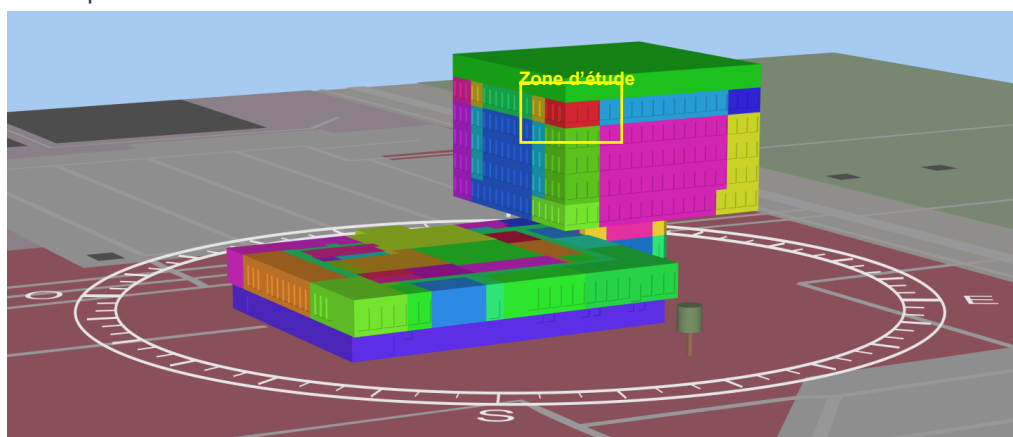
Plan 3D du zonage thermique du bâtiment complet
